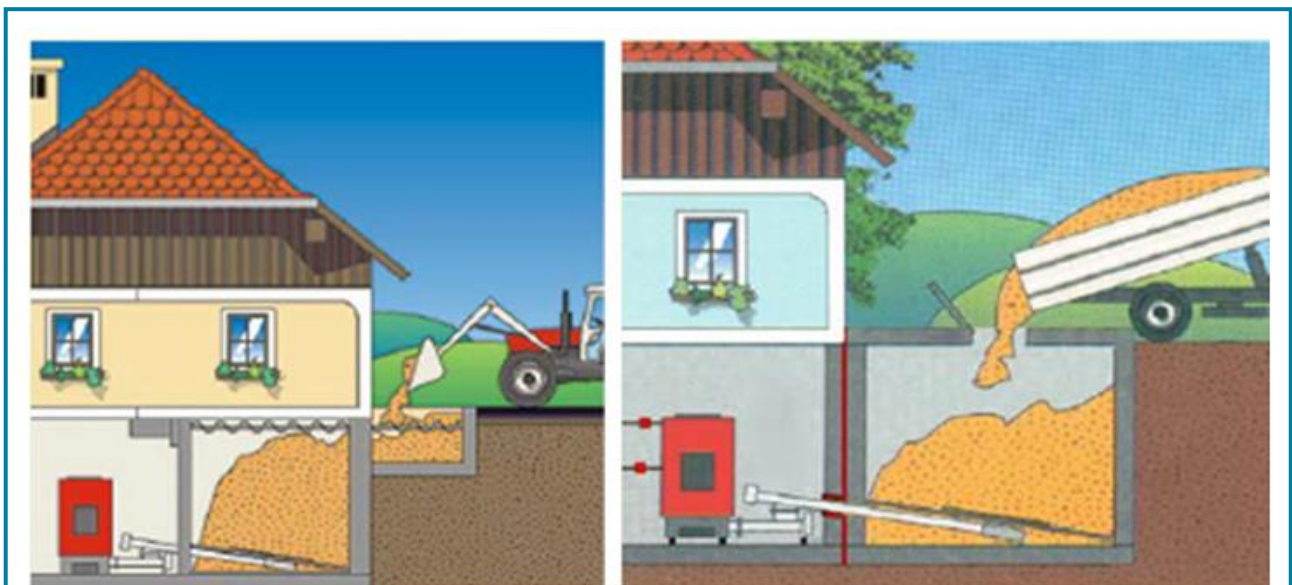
a) Lagerung im vorhandenen Keller - Lagerfüllschraube b) Separate Lagerung, einfach zu befüllen
